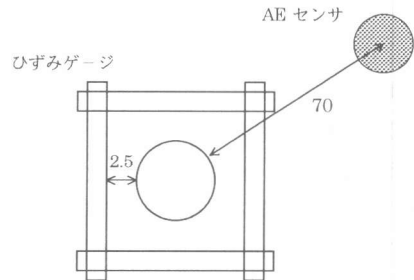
鉄筋周りのひずみゲージ・AE センサ配置図(mm)
